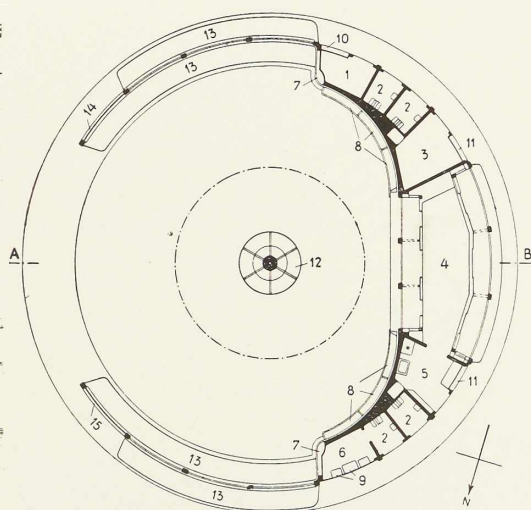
Vue en plan du pavillon circulaire du grand auvent.
